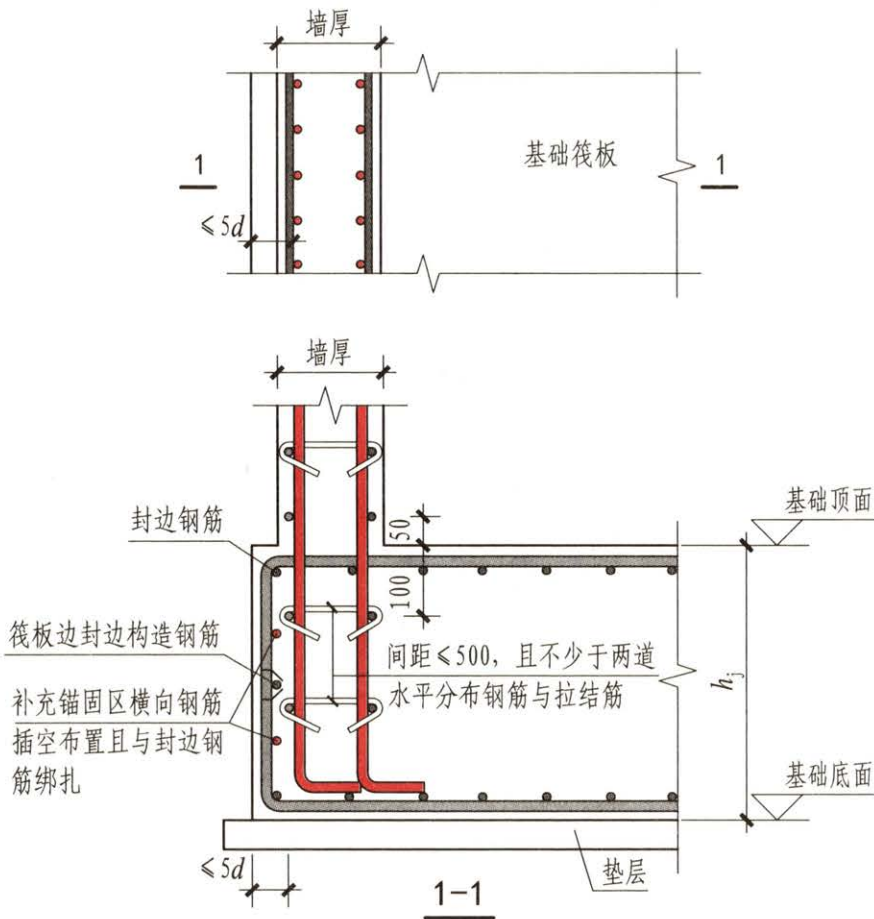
墙身插筋锚固区横向钢筋的排布构造 (一)
